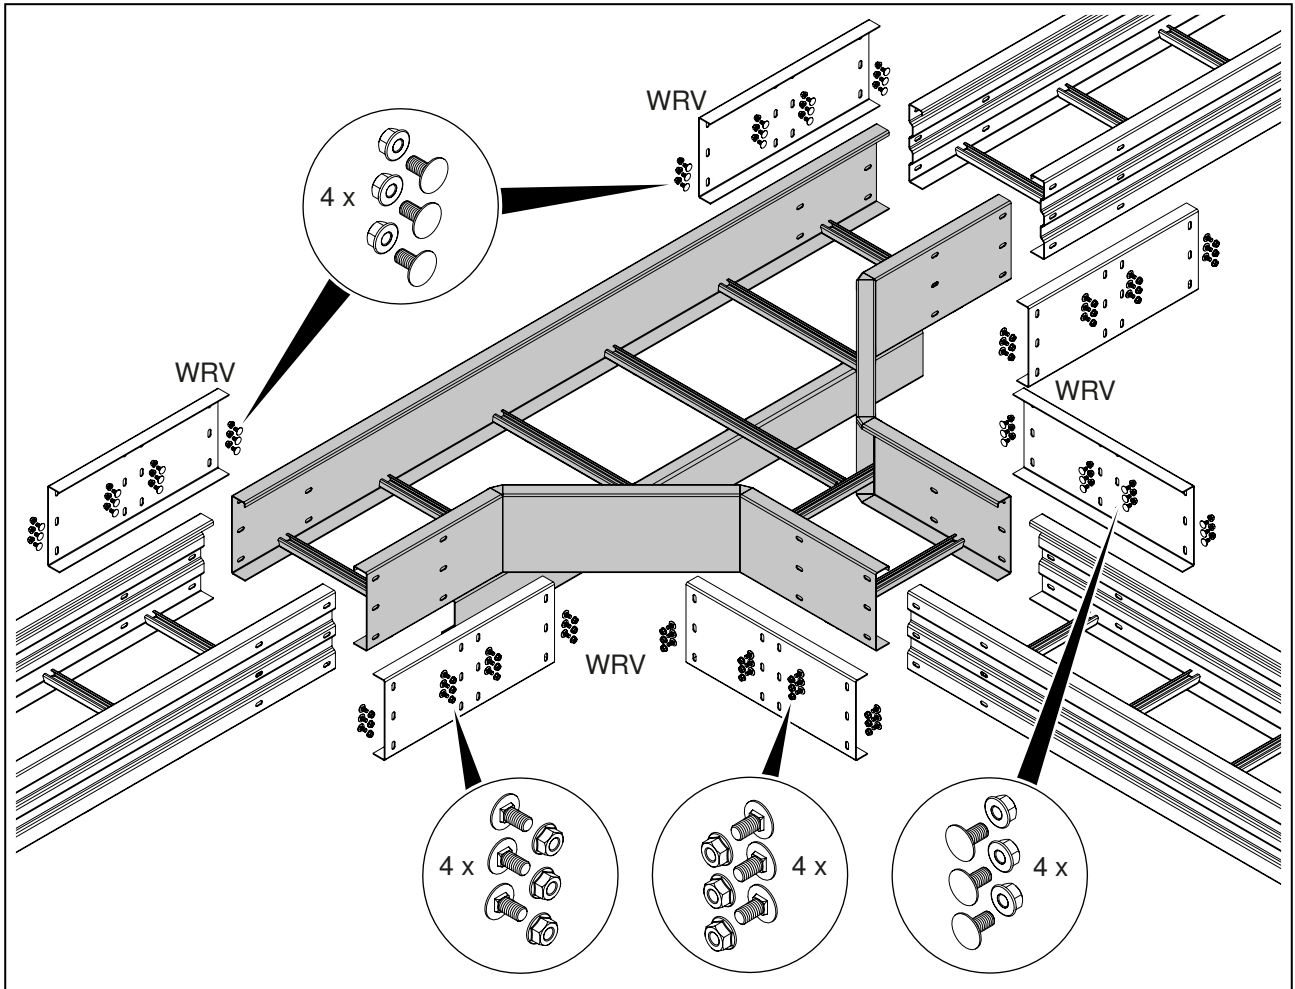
Bauteile für Montage T-Abzweigstück Seitenhöhe 160 mm
